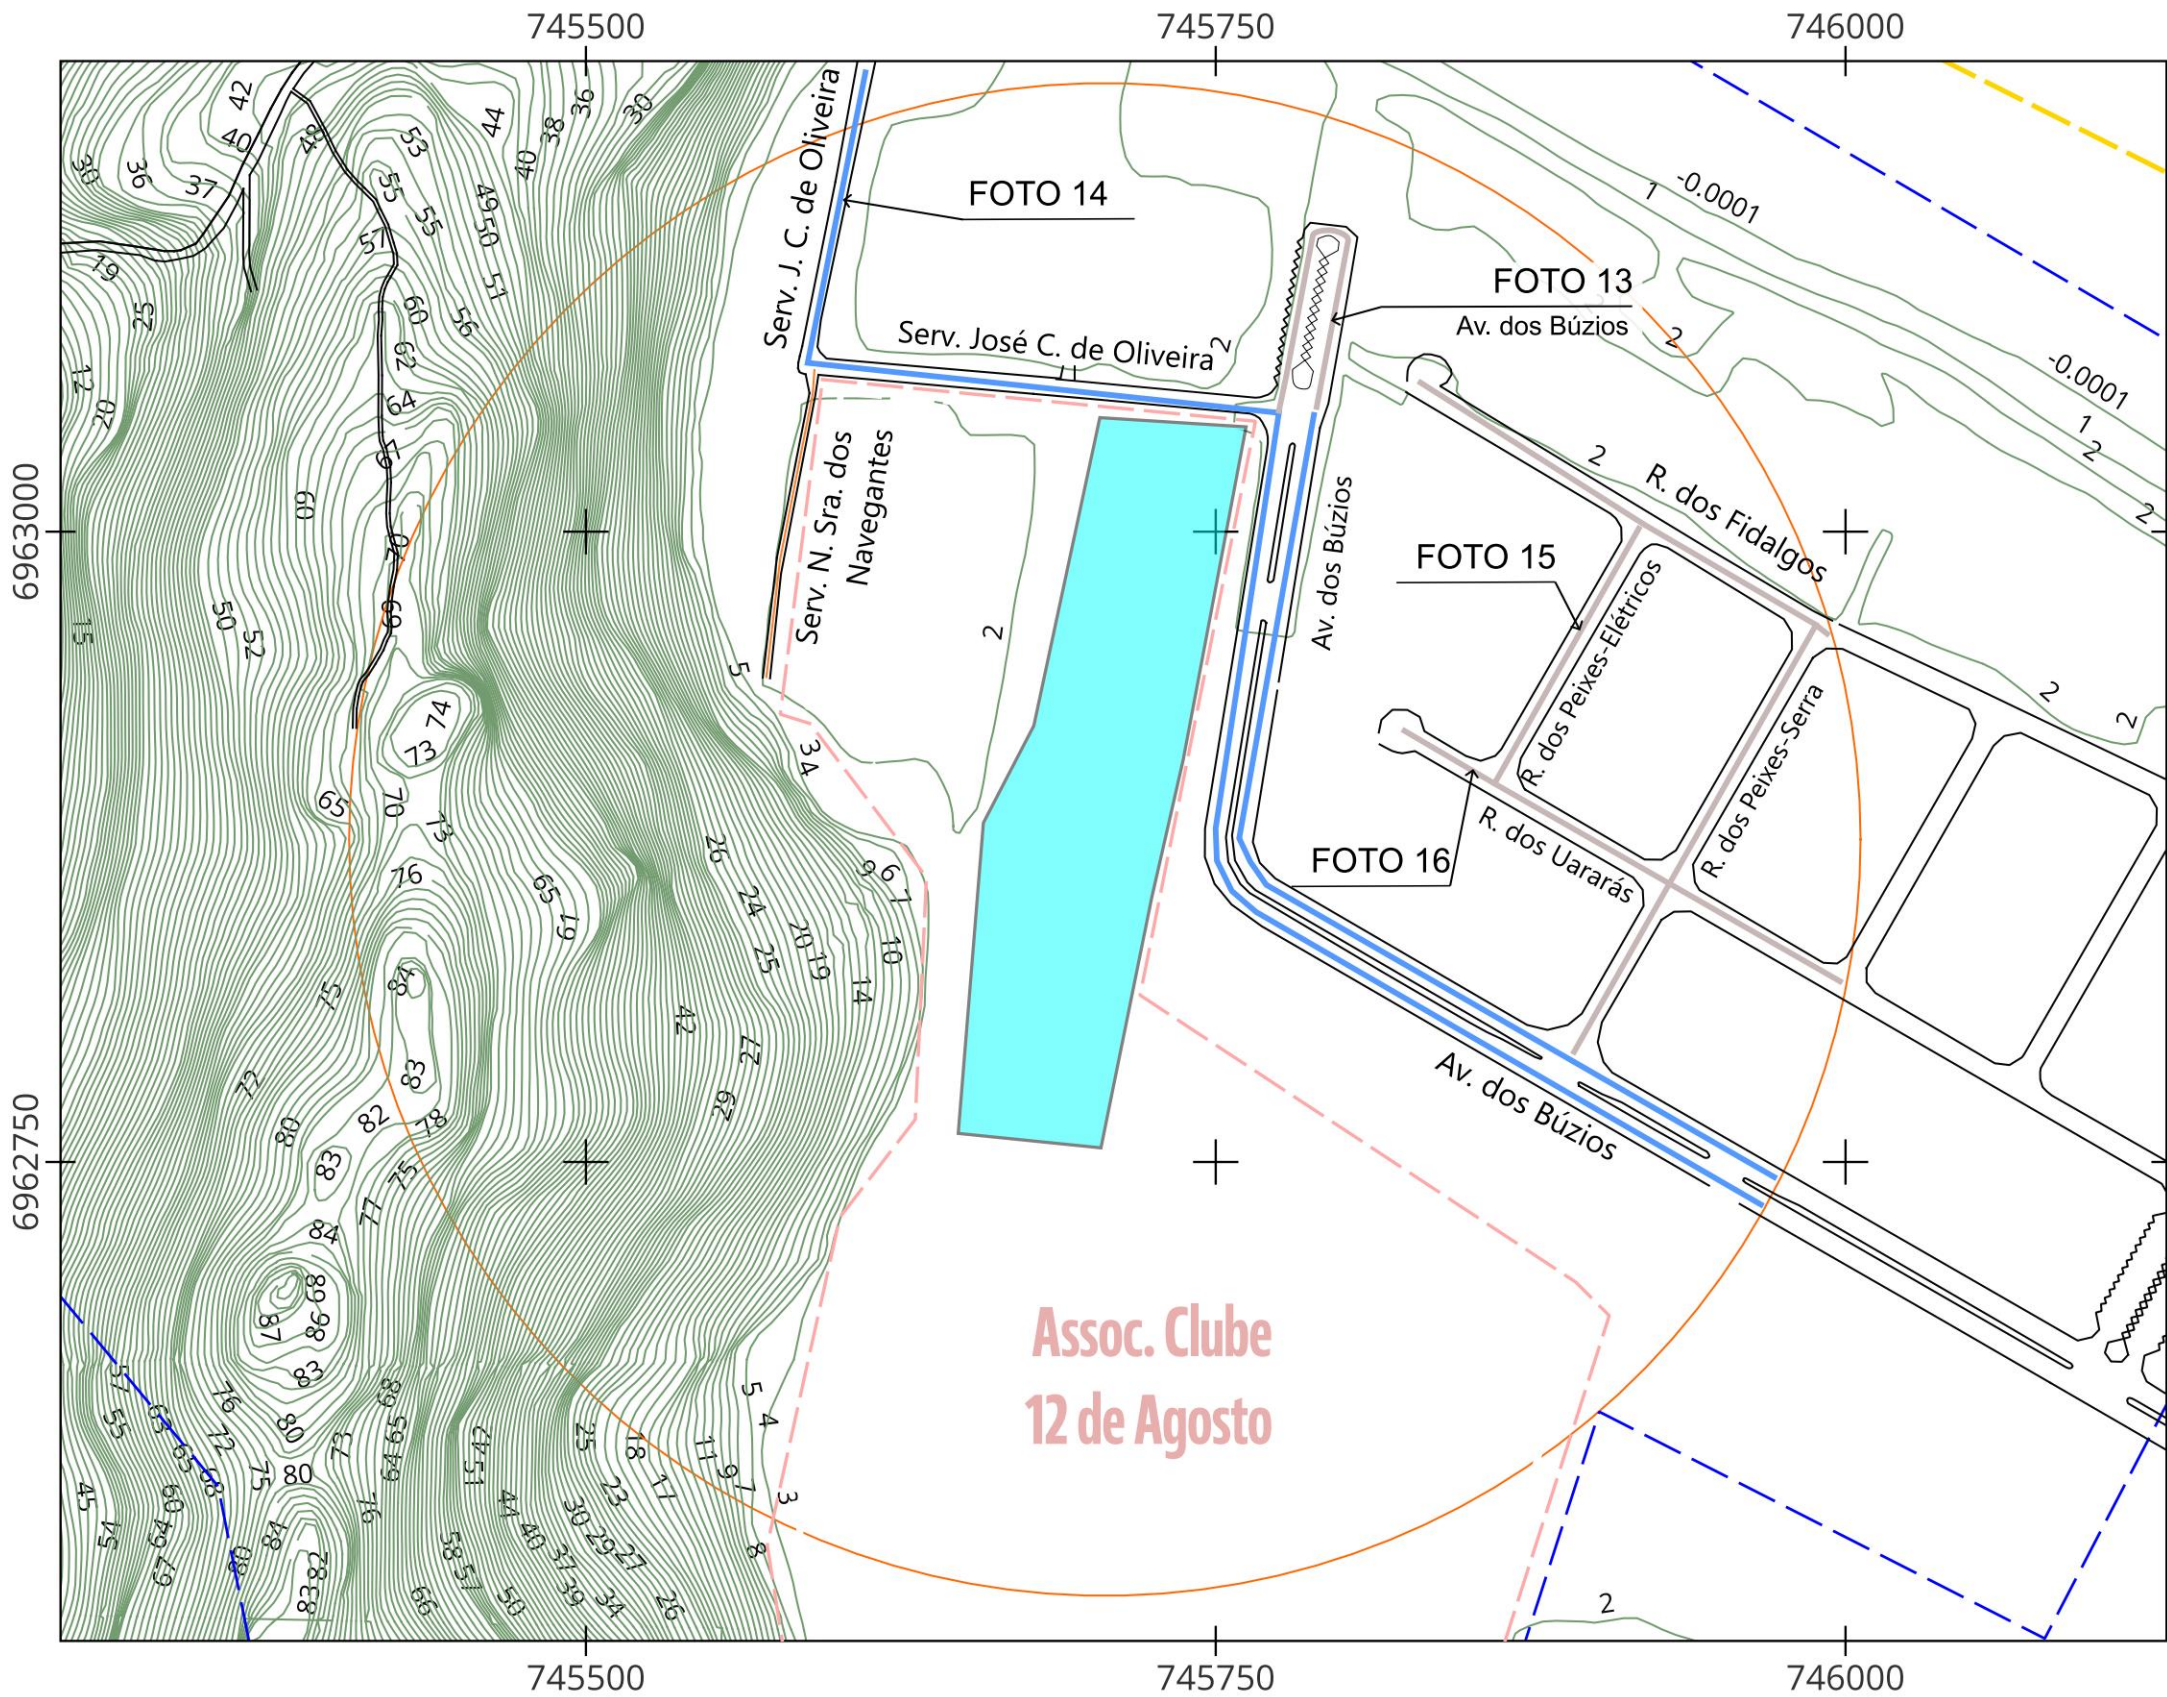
TÍTULO ARENA JURERÊ		ENDEREÇO Serv. José Cardoso de Oliveira, 85		TEMA: Pavimentação do Entorno  Sistema de Coordenadas Geográficas Projeção Transversa de Mercator Datum Hor. de Referência: SIRGAS 2000 - Zona 22 S Fontes: Levantamento expedito / ESRI Maps (2025) / IN 002/2025/SMH DU Adaptado pelo autor.
